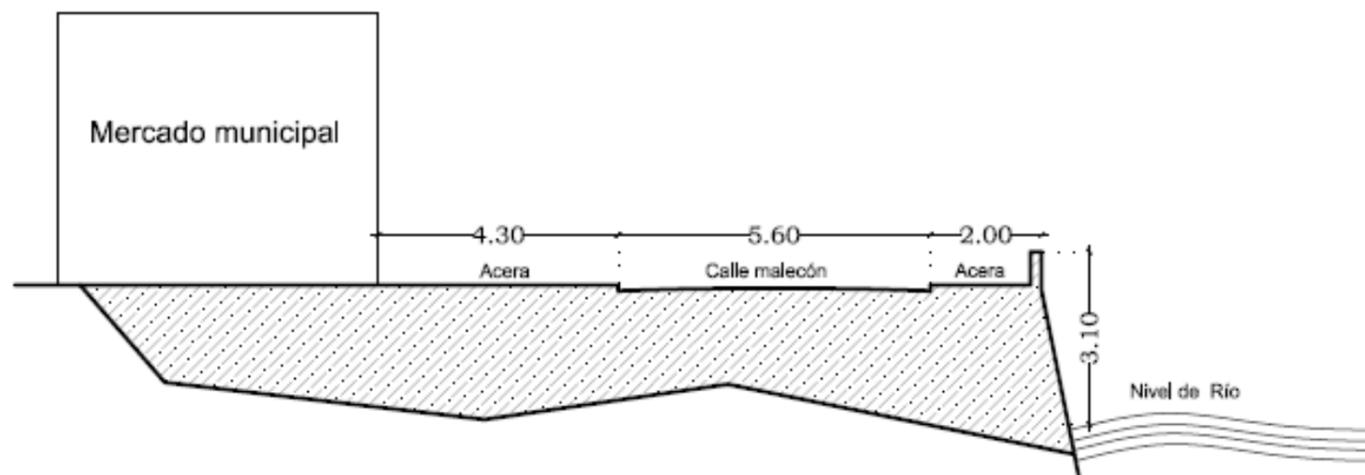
Corte A'A terreno de proyecto (Rivadeneira, 2014)
